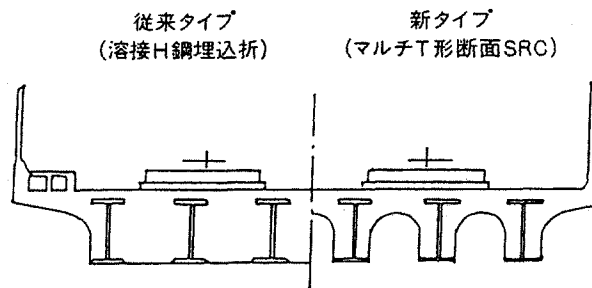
SRC 桁の断面図 (従来タイプと新タイプ)
